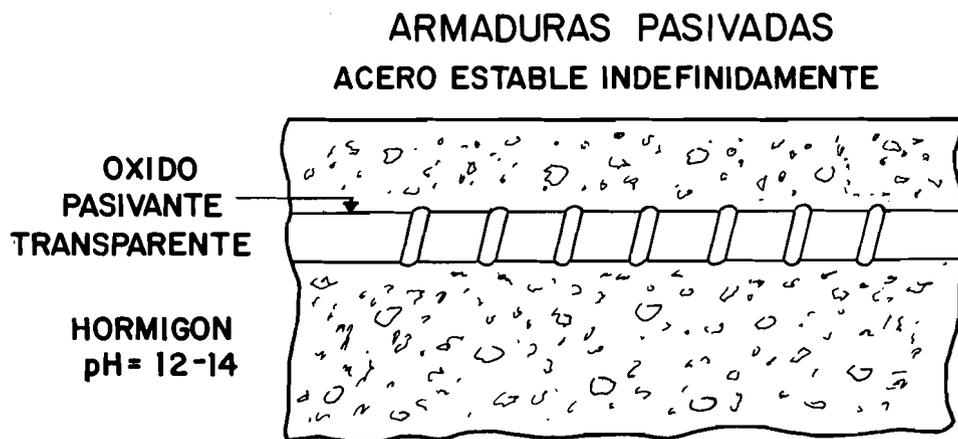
Armaduras embebidas en un hormigón sin contaminar.
